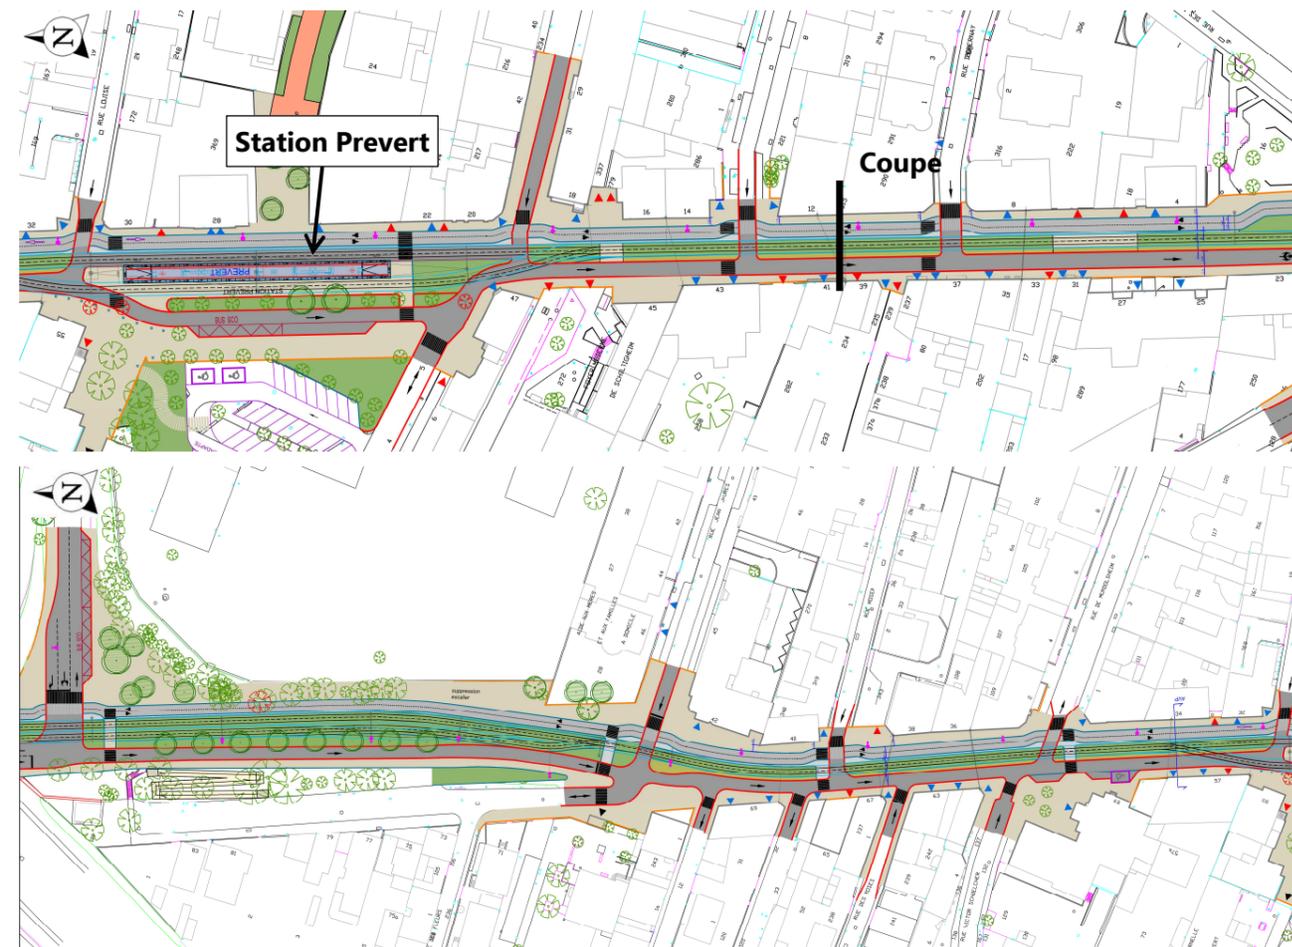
Plan de la route du Général de Gaulle Sud (source : AVP, GETAS 2023)
